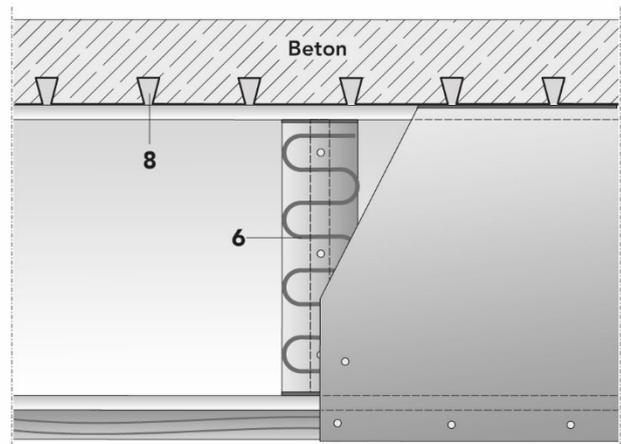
Anschluss an Stahltrapezblechdächer – Variante 2
